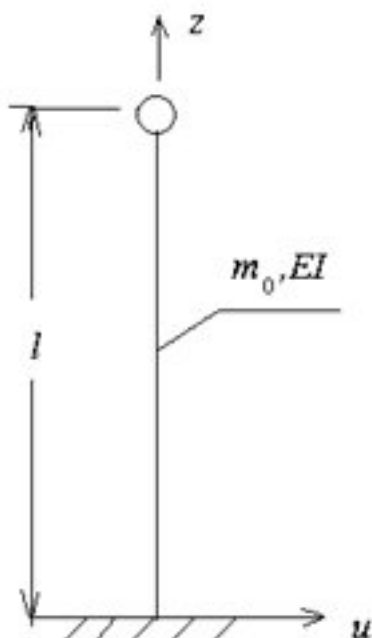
Традиционная расчетная схема КНС. Расчетная схема без сейсмоизолирующего скользящего пояса с жестким защемлением и закреплением КНС в увлажненном грунте.
